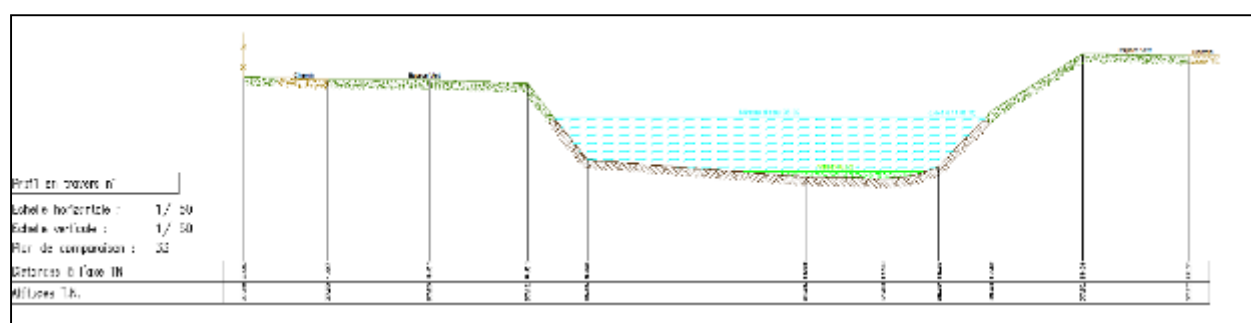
Vue en coupe d'un profil en travers type de l'Orge en amont du clapet.
